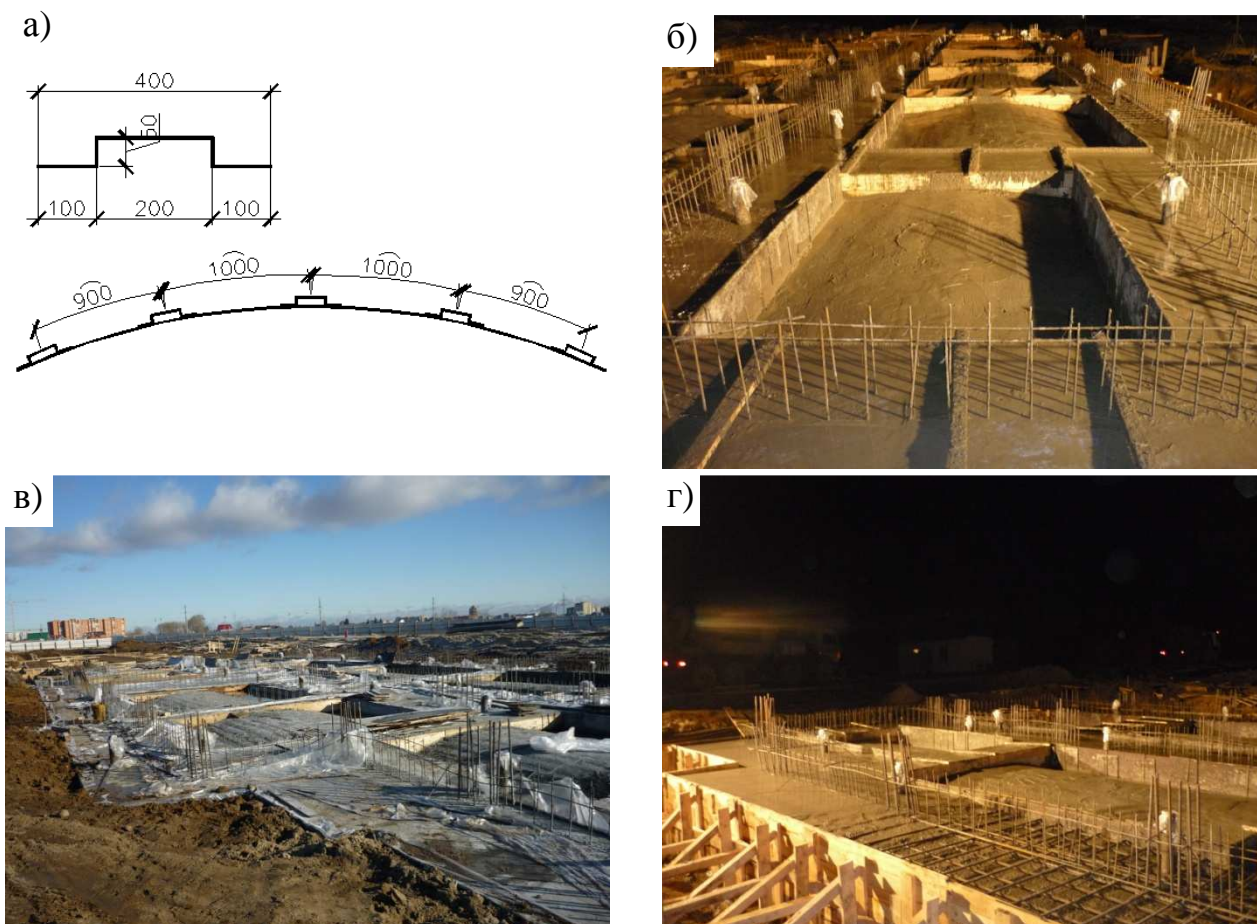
Бетонные работы: а – маяки для бетонирования оболочек; б, г – бетонирование оболочечной и плитной частей; в – защита бетона полиэтиленовой пленкой.
